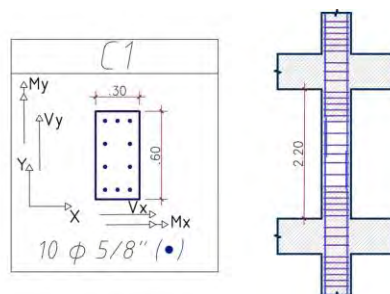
Sección y armadura elegida para la columna C1 dimensiones en (m).
